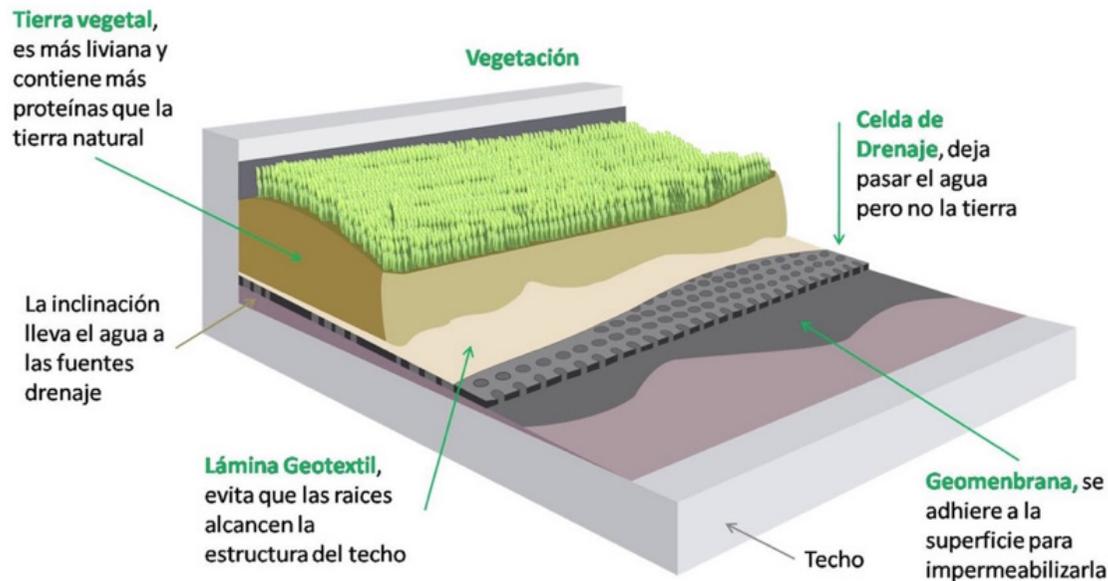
Esquema detallado de un sistema de cubierta verde.
